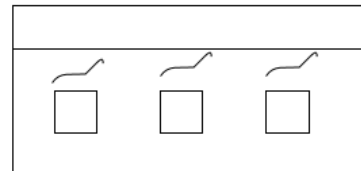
Чрезмерные нагрузки на перекрытия – прогиб балки перекрытия
